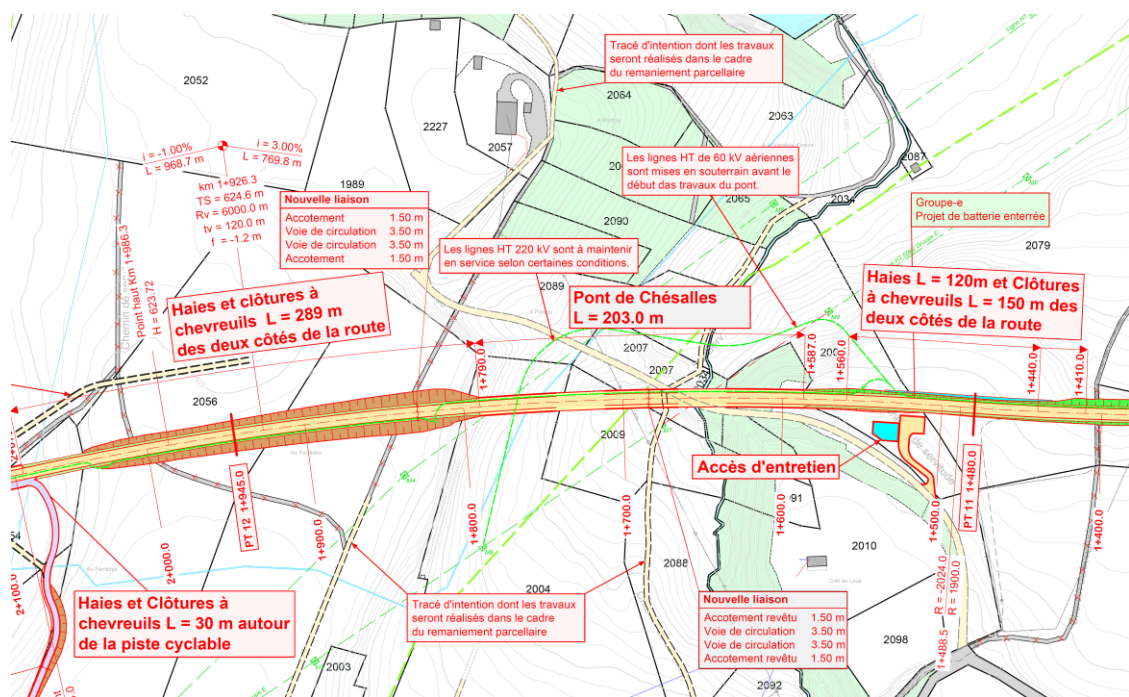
Situation tranchée et pont de Chésalles – extrait plan EMMA+ (04.12.20)
